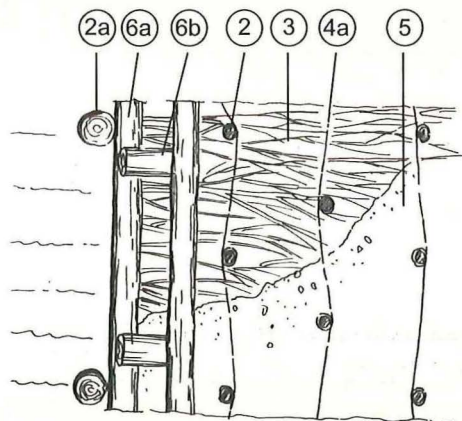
Weidenspreitlage mit Fußsicherung durch Holzkonstruktion (Draufsicht) (Quelle: Stowasser)
